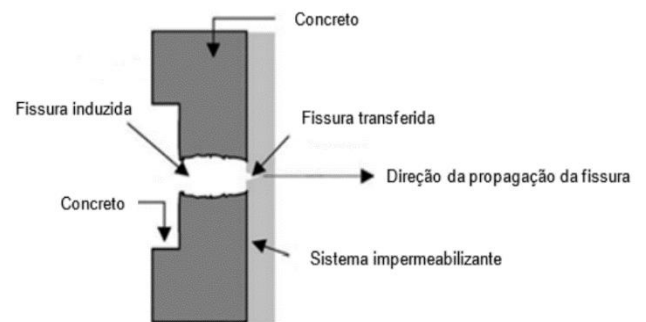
Transferência da fissura da camada mais interna (substrato) para a mais externa (membrana).
